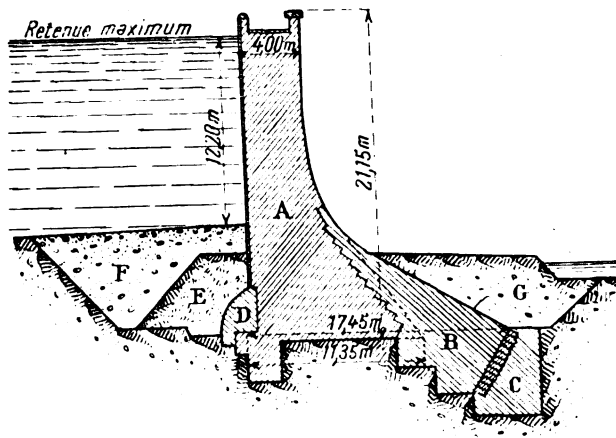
Profil du barrage de Bouzey sur le canal de l'Est : A, mur primitif; B, massif de butée; C, sommier; D, solin; E, argile corroyée; F, sable, gravier et pier-aille; G, remblai en tout-venant.
